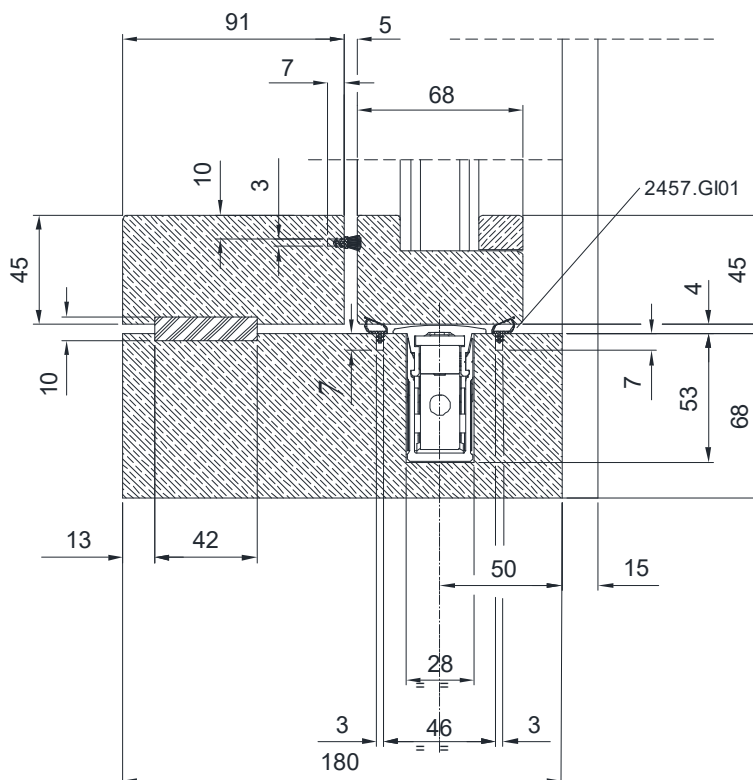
Section du nœud latérale - vantaël ouvrante- serrure 27 mm (dimensions nominales déclarées, exprimées en mm)
